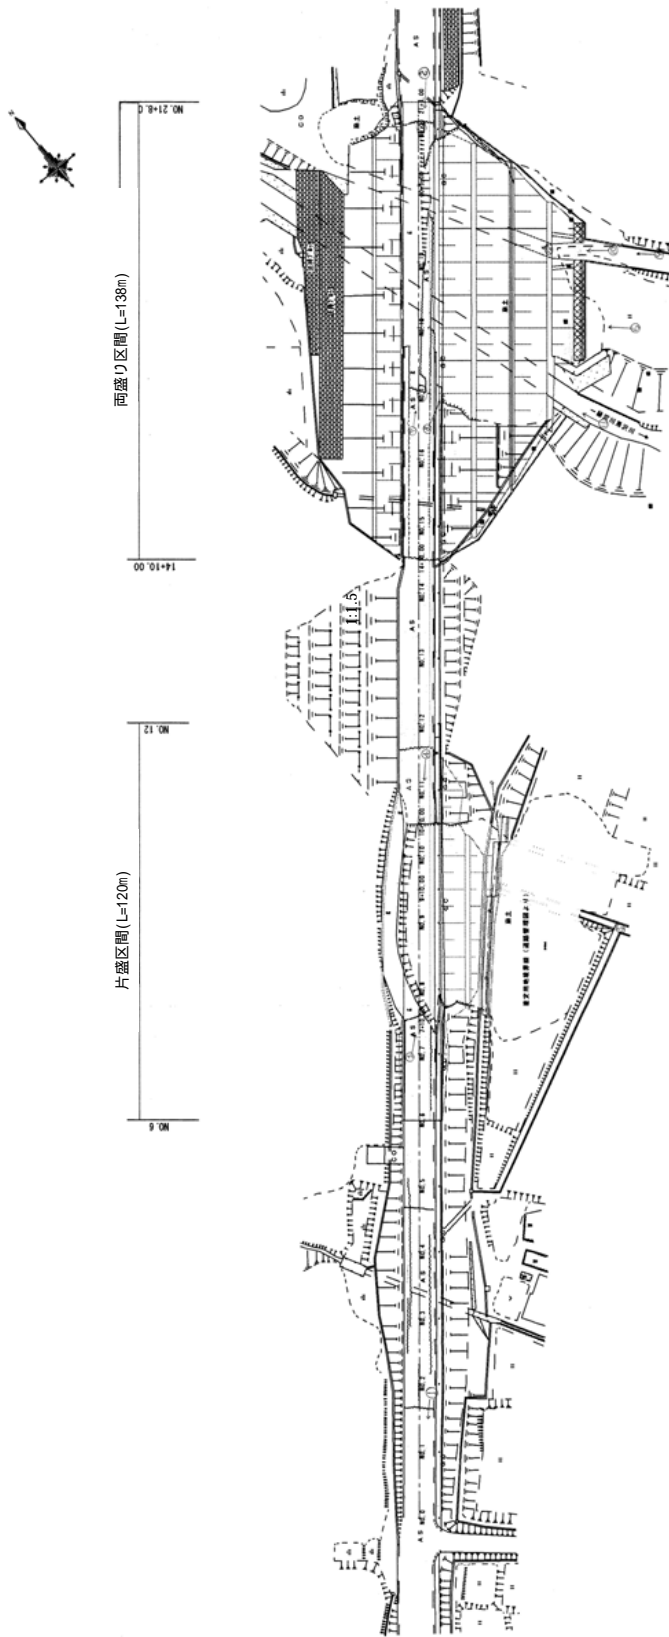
小千谷市細島の崩壊盛土周辺の平面図（国道117号）
